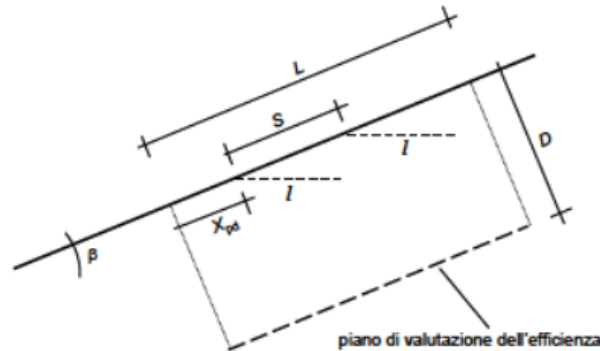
Schema di installazione dei dreni – sezione longitudinale.
